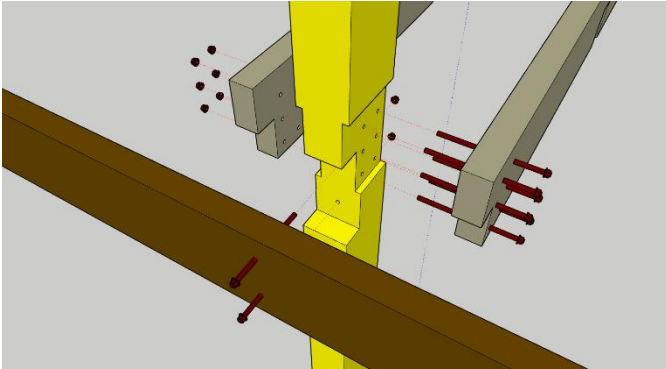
Узел крепления к колонне обвязочных балок и балок покрытия
